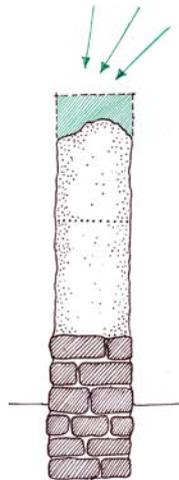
Pérdida de sección por lavado de un muro de tapia.
